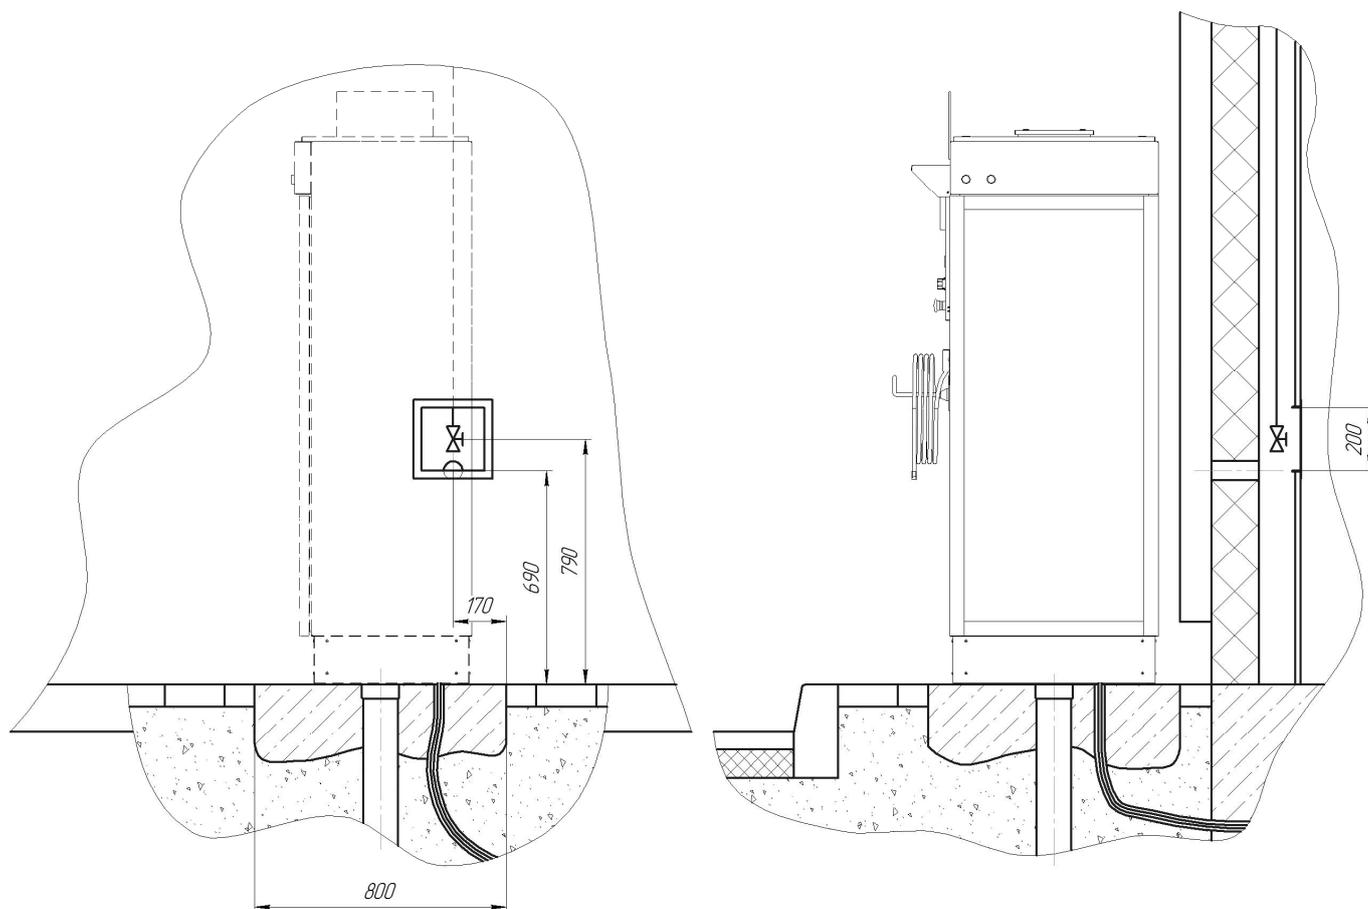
Схема размещения запорной арматуры за внутренней отделкой
